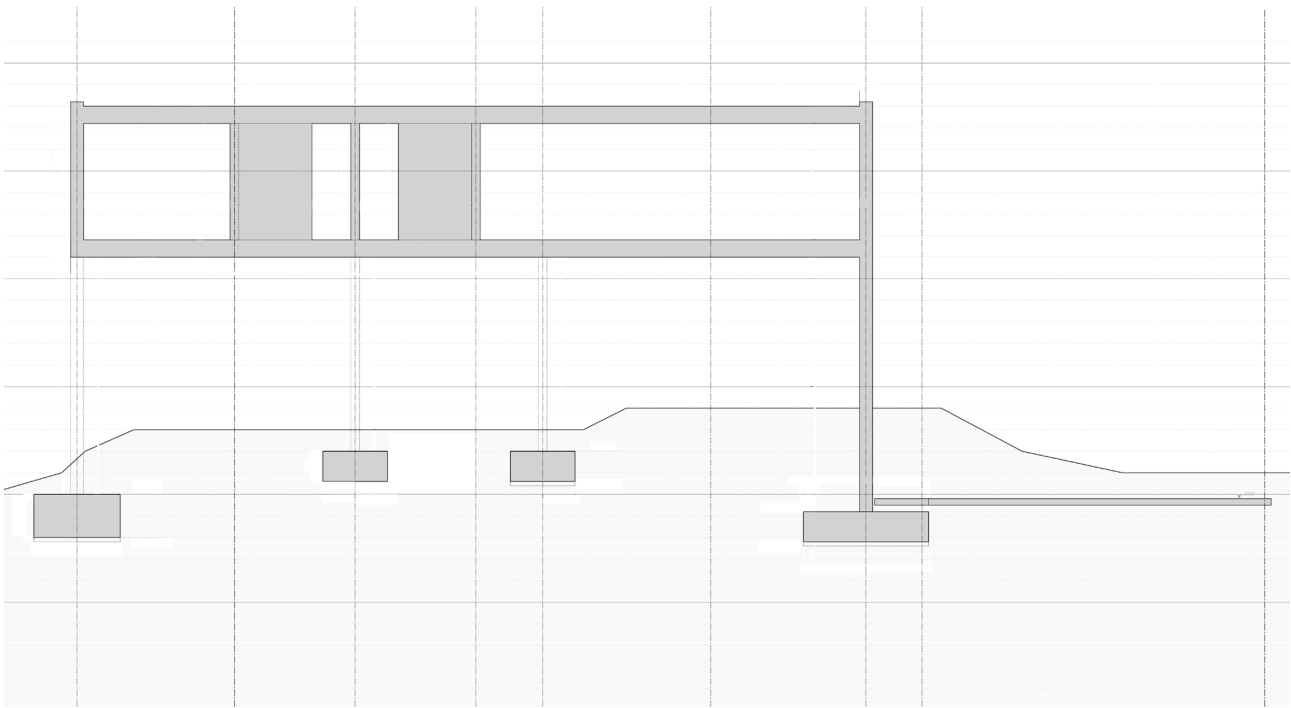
Sección estructural longitudinal. Pantallas y cimentación
